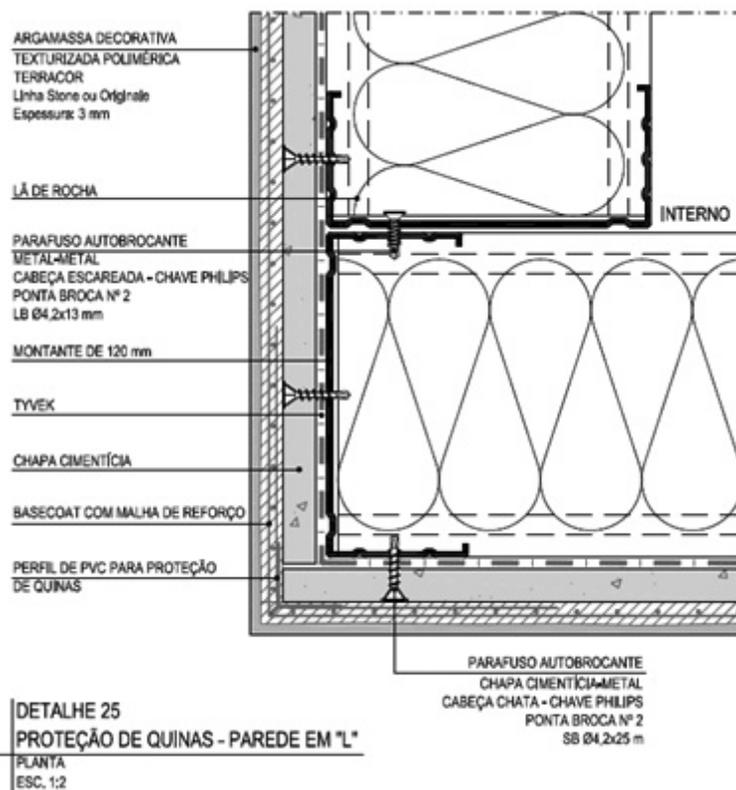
Detalhe em planta mostrando os componentes e acessórios utilizados no canto externo da fachada em LSF. Notar o cuidado com proteção e reforço no encontro entre as placas cimentícias e a fixação dos montantes verticais. (Acervo INOVA-TEC CONSULTORES)
